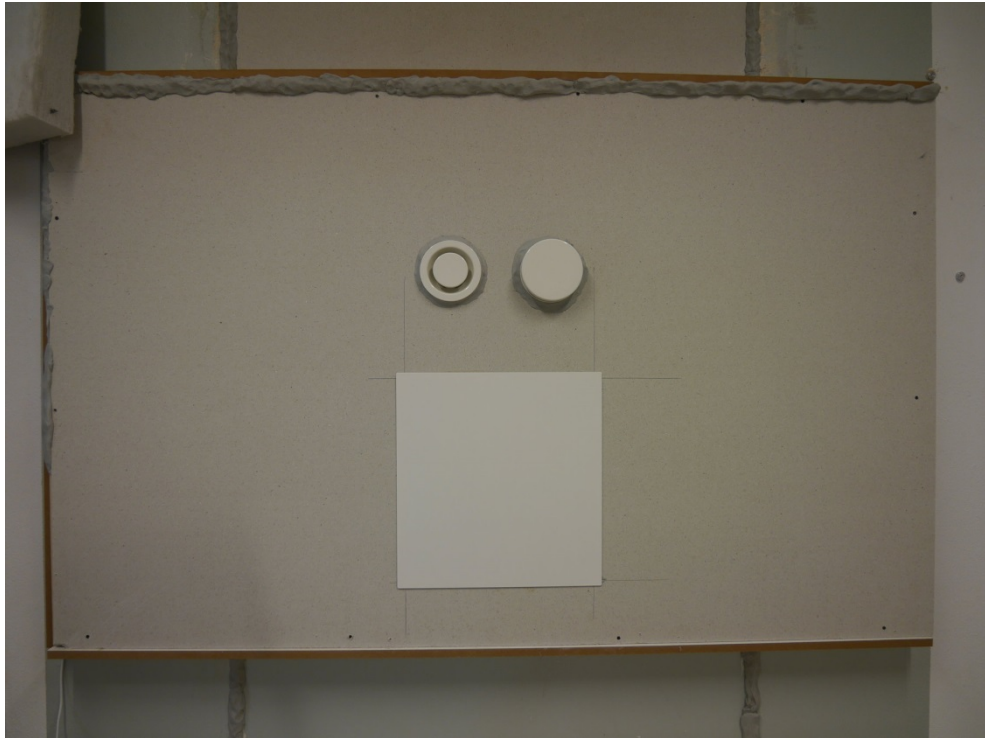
Einbauvariante U<sup>2</sup>: Raumseitige Ansicht Lüftungsgerät; Standardeinbau Ein-Raum-Variante prüffertig, Tellerventil ABL bzw. ZUL und Abdeckung U<sup>2</sup> montiert.
